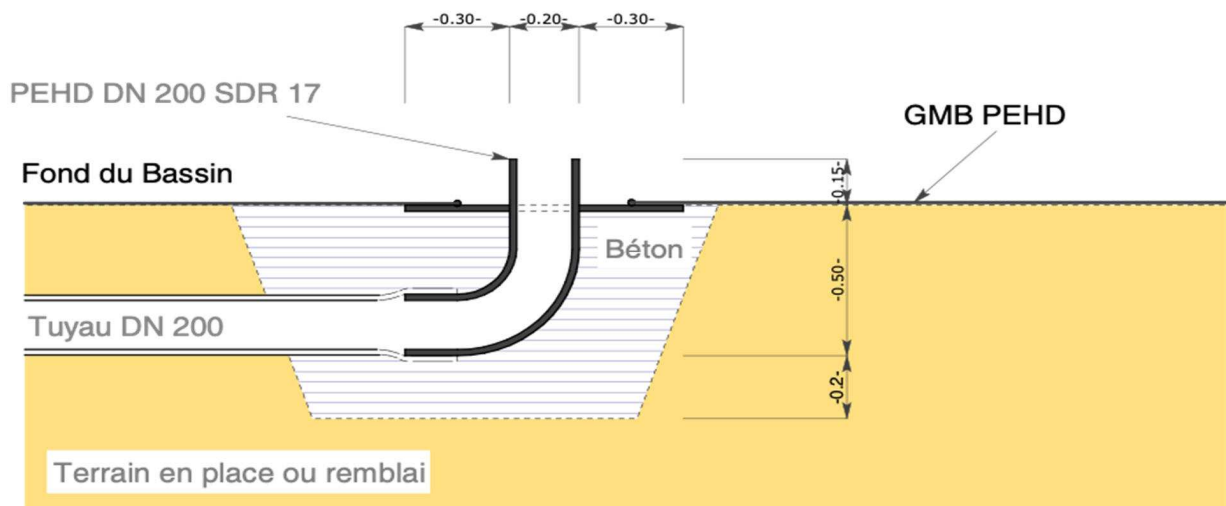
Vue en coupe : Prise d'eau de Fond DN 200 Bassin des eaux du casier amiante lié
